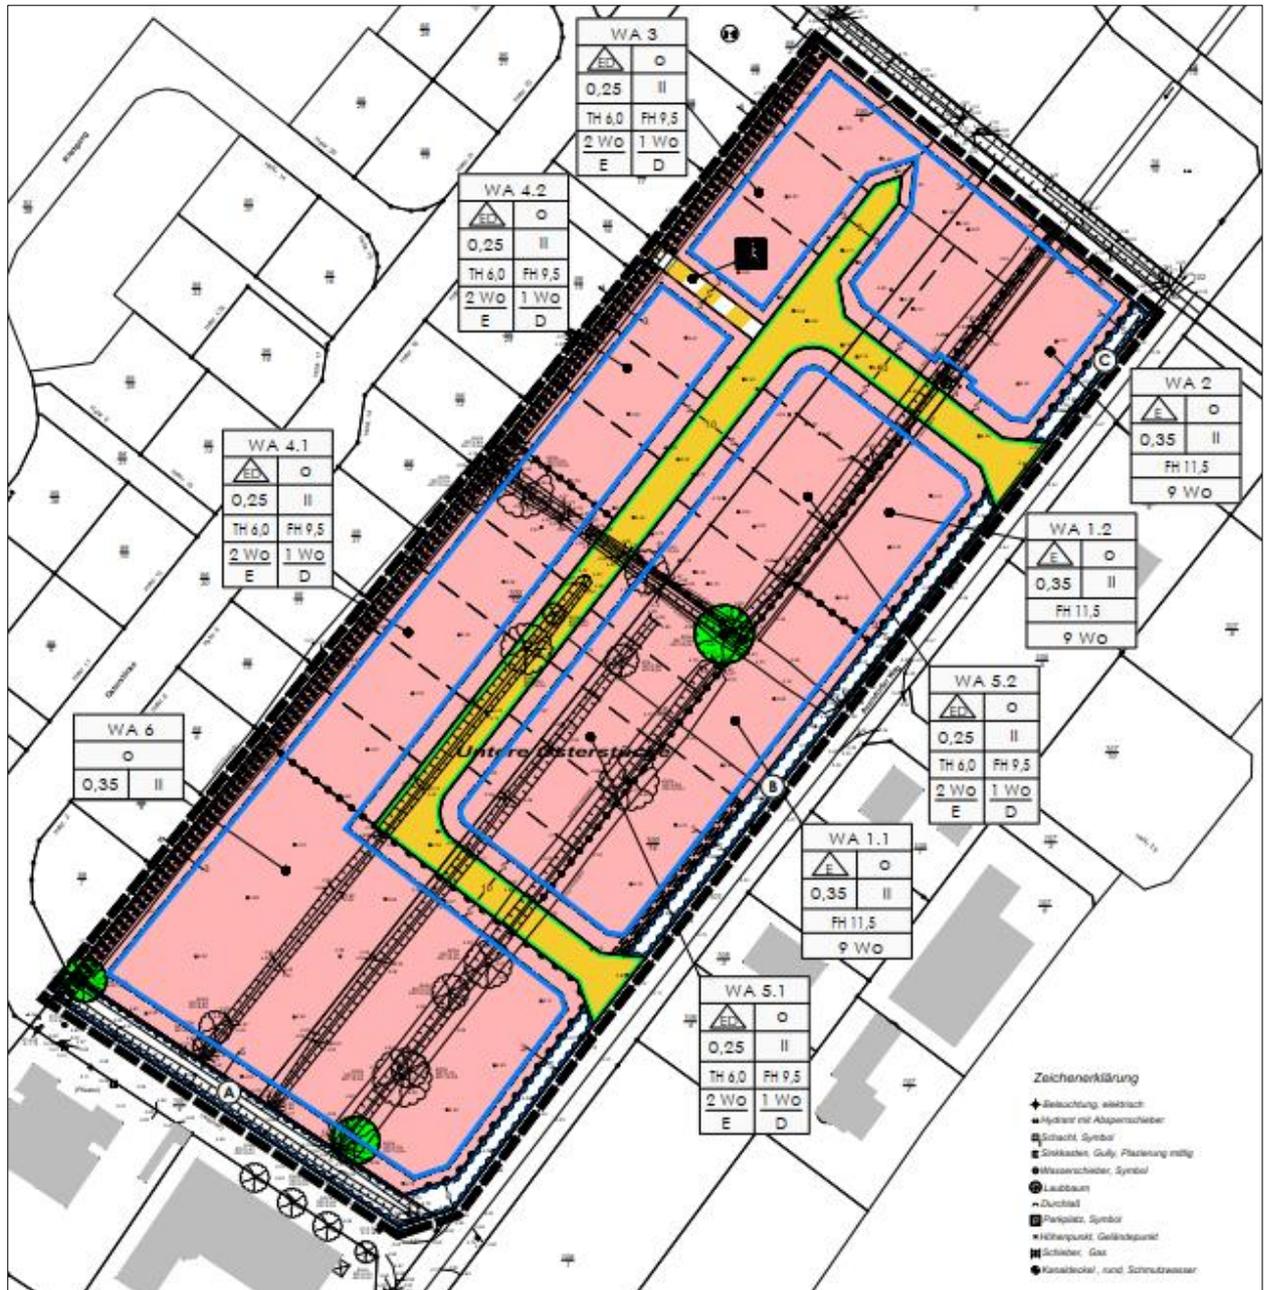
„Bebauungsplan Nr. 26 "Am Avendorfer Weg" gem. § 13b BauGB mit 1. Änderung B-Plan Nr. 18 "Untere Osterstücke", Entwurf Stand 05.12.2019"
